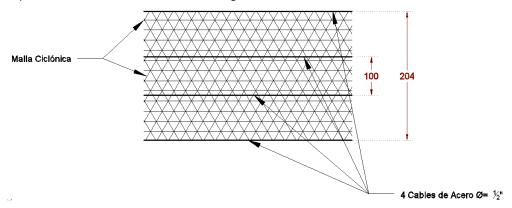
Vista en planta del andador trapezoidal. Ref. 14
